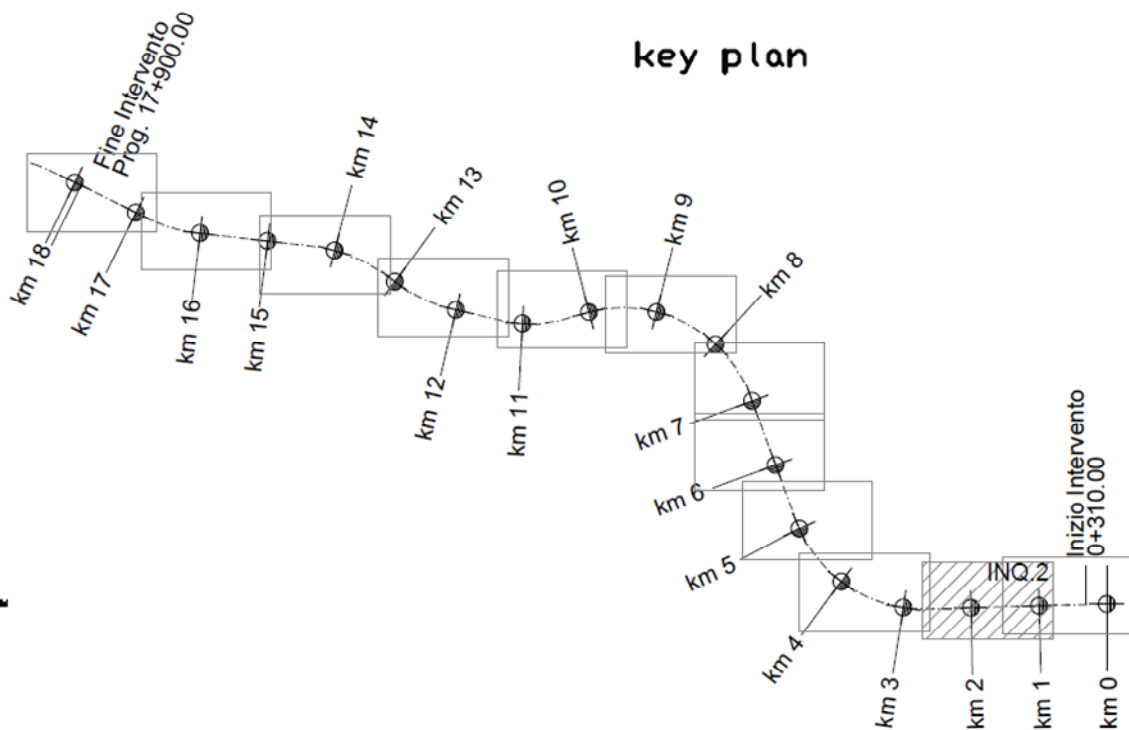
Planimetria generale del tracciato ferroviario Apice - Hirpinia
